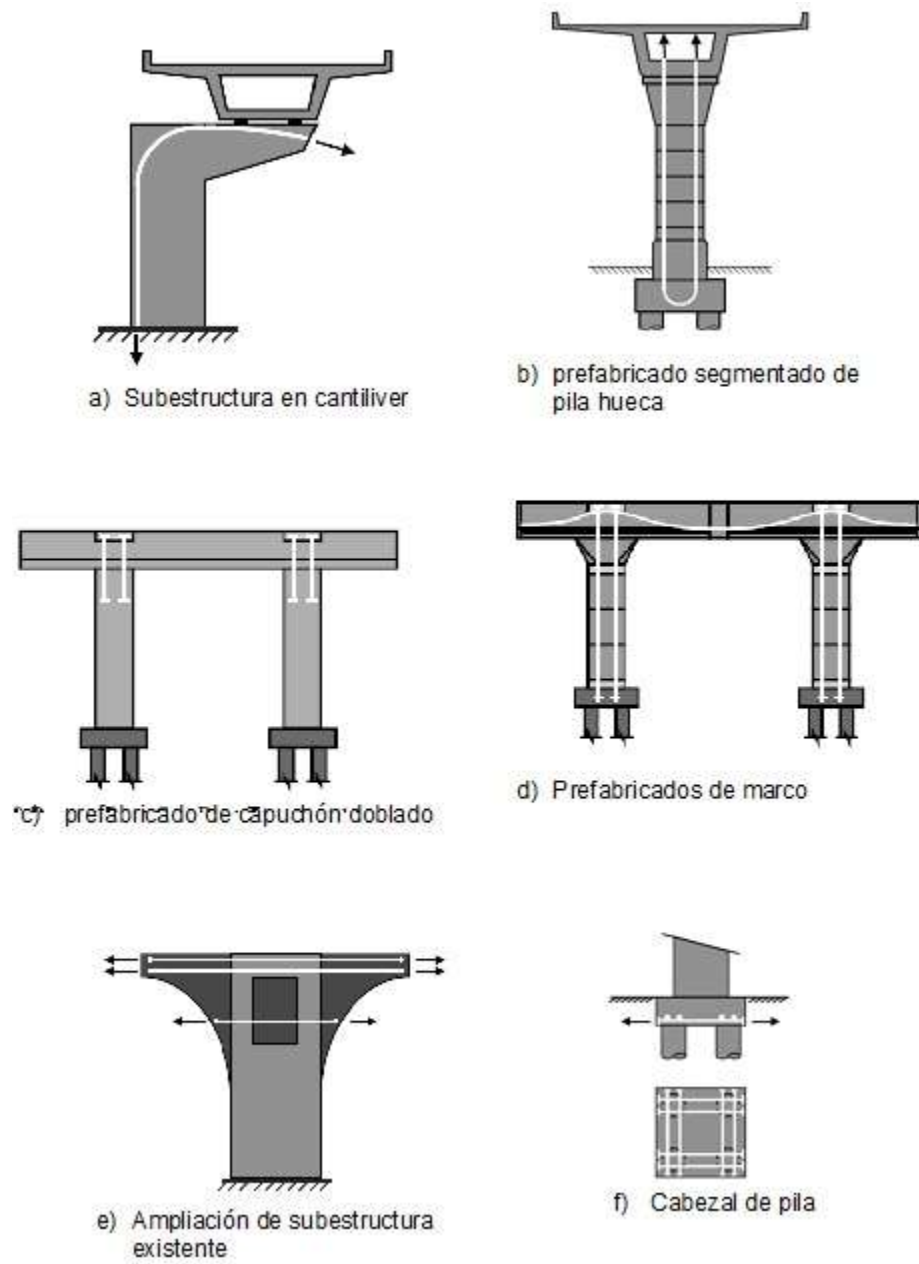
Aplicaciones del postensado en subestructuras de puentes
